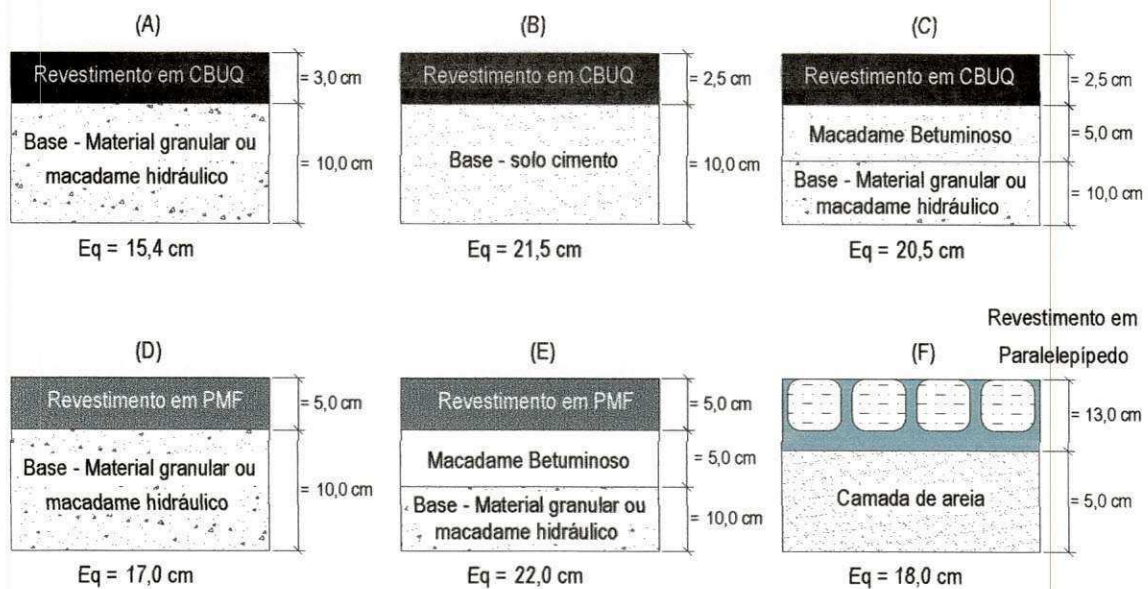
Projetos-tipo de pavimentos para o tráfego muito leve, método proposto (GUEDES, 2008).
